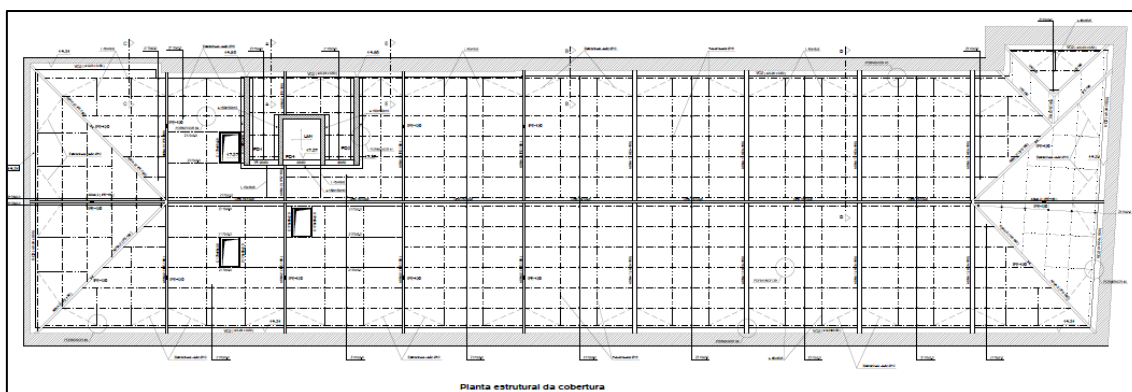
Planta estrutural da cobertura (planta definida para reabilitação) [22]
